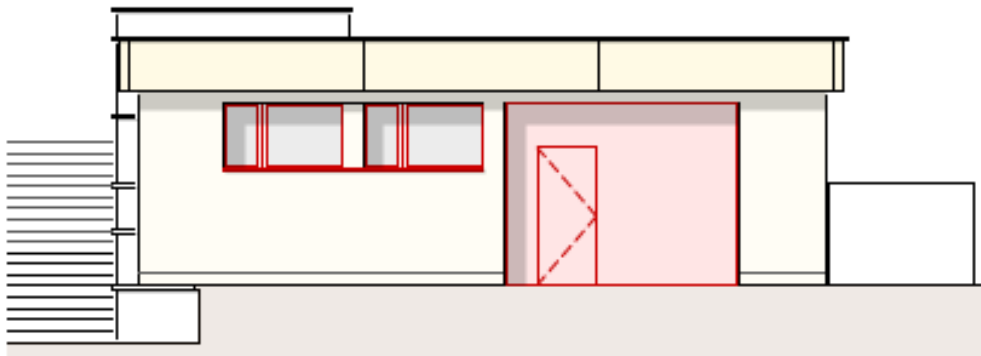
; Plan Fassade Nord-West mit Ansicht neues Tor
